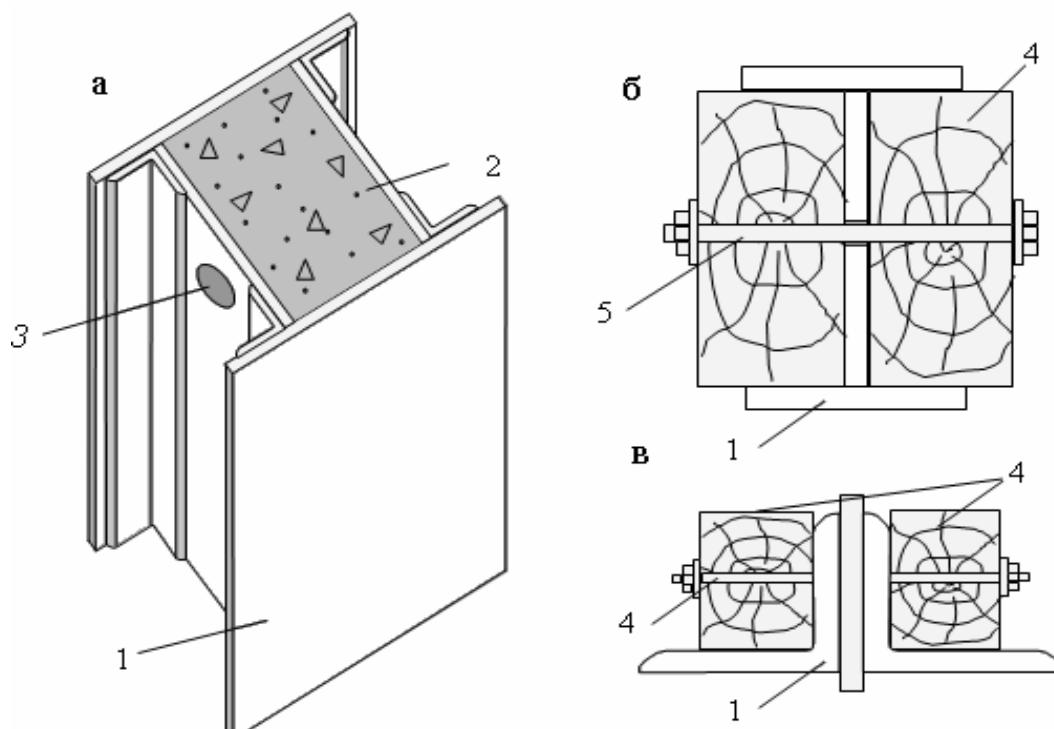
Усиление стенок стальных конструкций: *а* – заполнением полости колонны бетоном; *б, в* – прикреплении деревянных брусьев; 1 – усиливаемая стальная конструкция, 2 – бетон, 3 – отверстие в стенке для заполнения бетоном, 4 – деревянные брусья, 5 – стяжной болт
